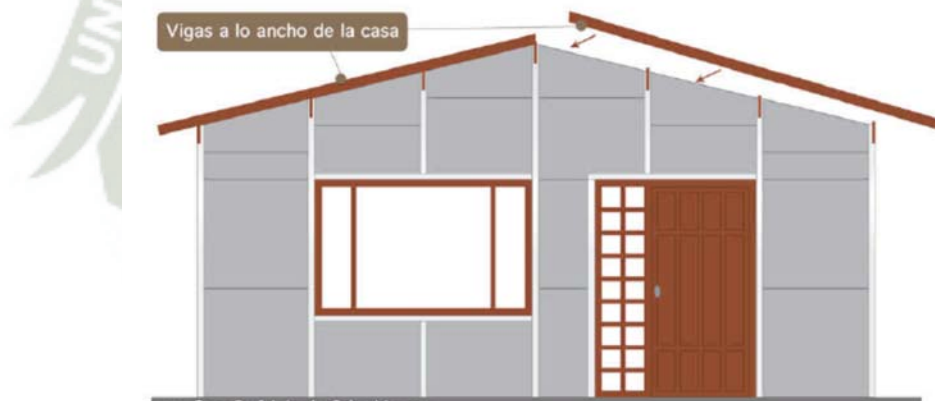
Ensamblaje de placas de pared frontal con vigas del techo. CADECOL
